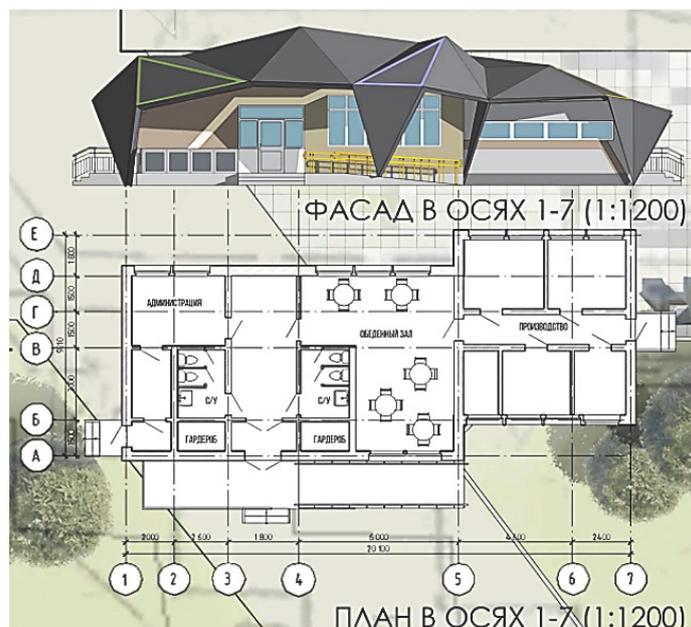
Фасад и планировочное решение остановочного пункта для персонала общественного транспорта
